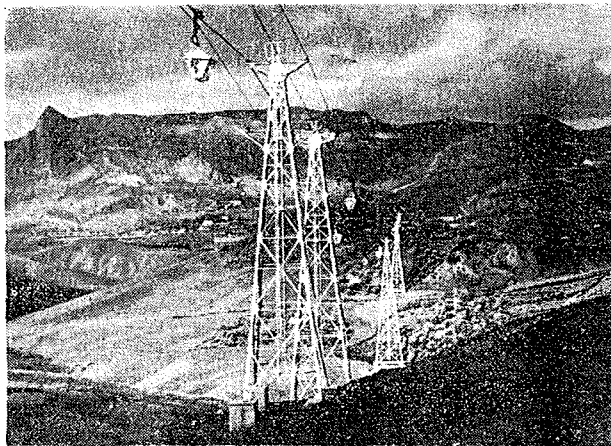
PILONI DI SOSTEGNO n. 102 e 103 (in primo piano): Fondazioni costituite da elementi ad X di diaframma.
